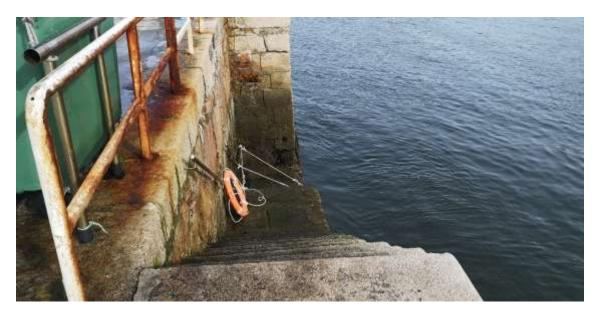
Detalle de las escaleras de descarga. Fuente: ACADAR
